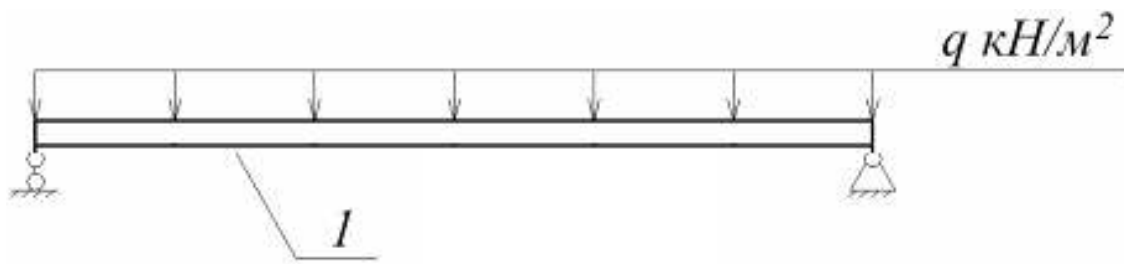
Схема испытания фрагмента бескаркасного цилиндрического свода
